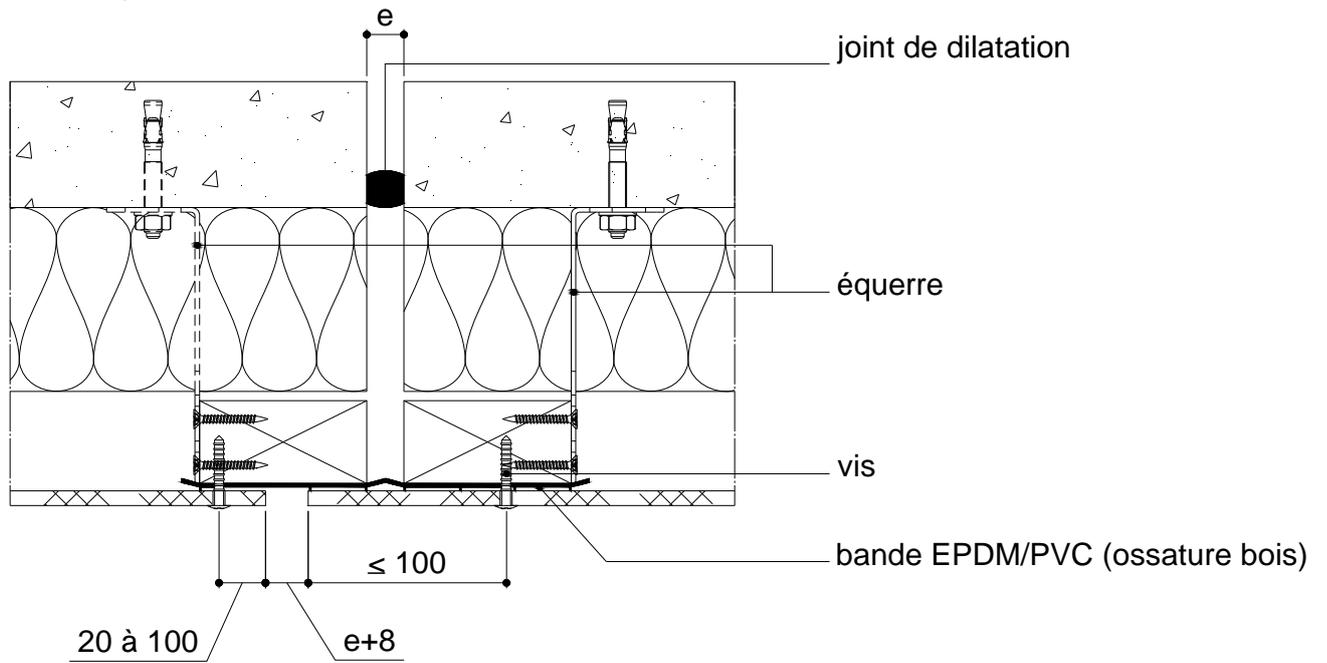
Détail joint de dilatation sur ossature bois ou métallique (cote en mm)
